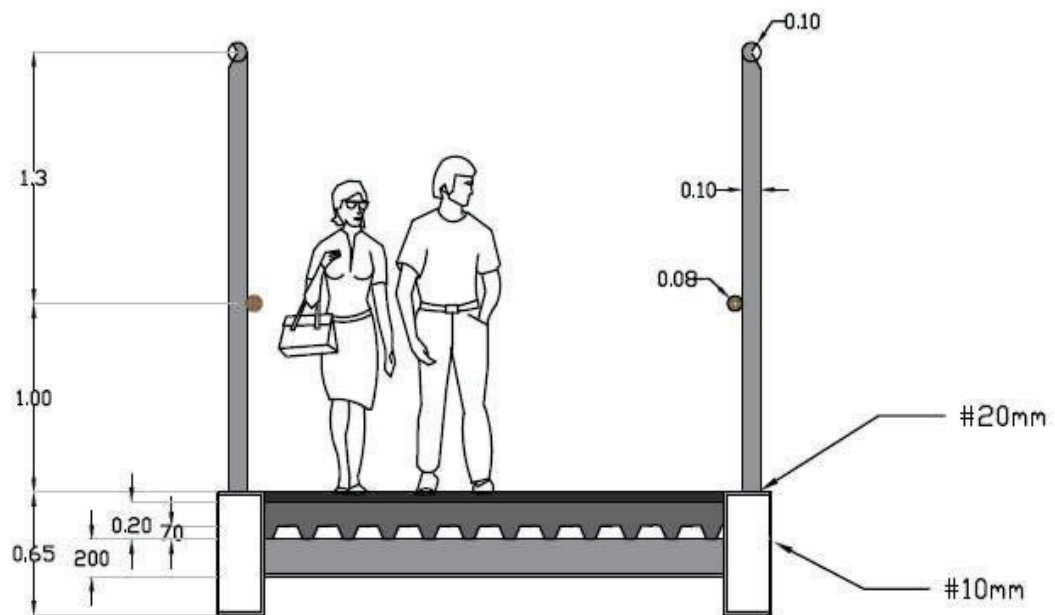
Sección transversal de la alternativa 3 propuesta por la alumna Alba Alvez
